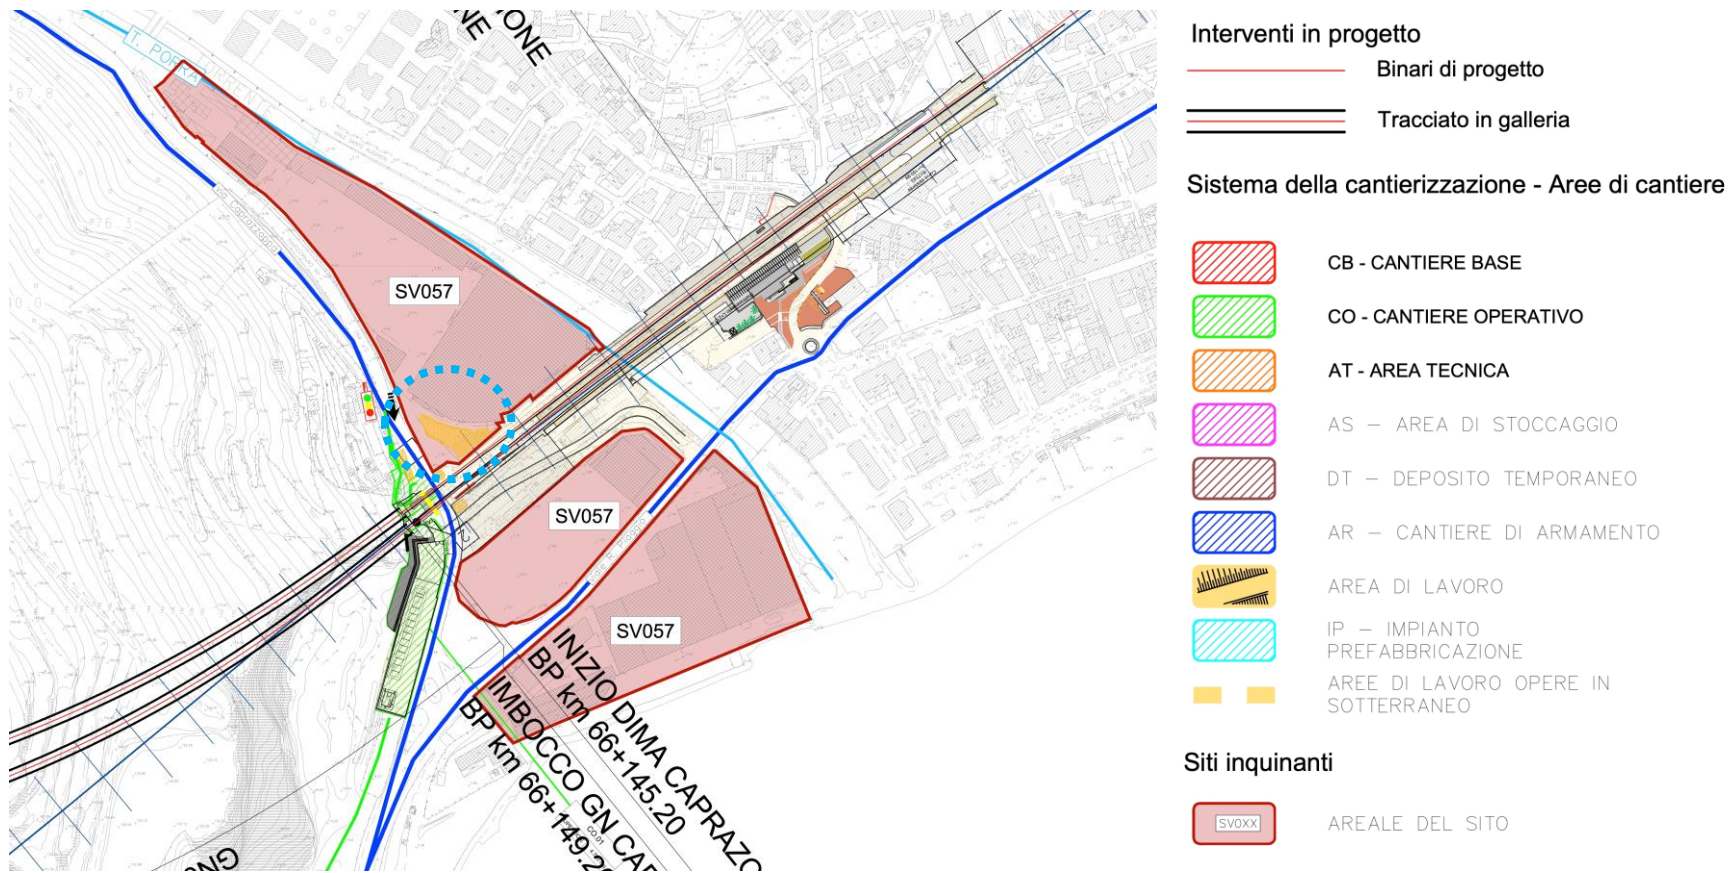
Dettaglio perimetro Sito SV057 con opere e aree di cantiere. Cerchiata in azzurro la demolizione prevista.
